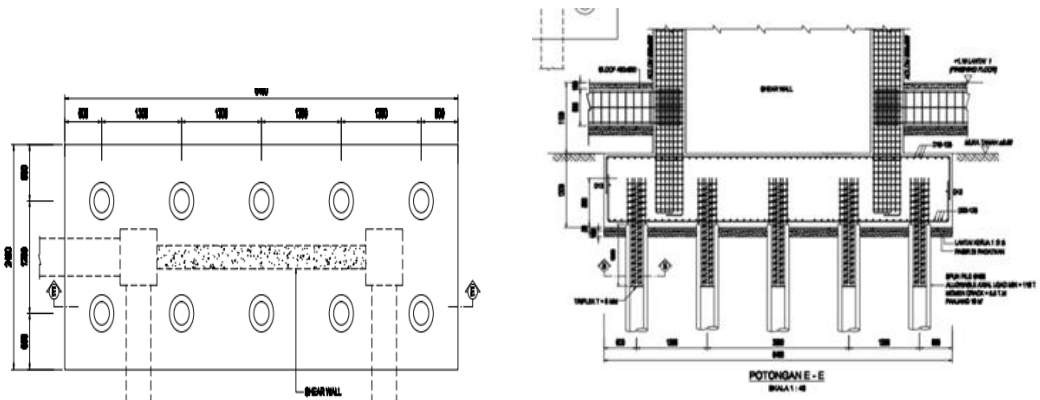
(a) Pondasi 1 Tampak Atas (b) Pondasi 1 Tampak Samping
